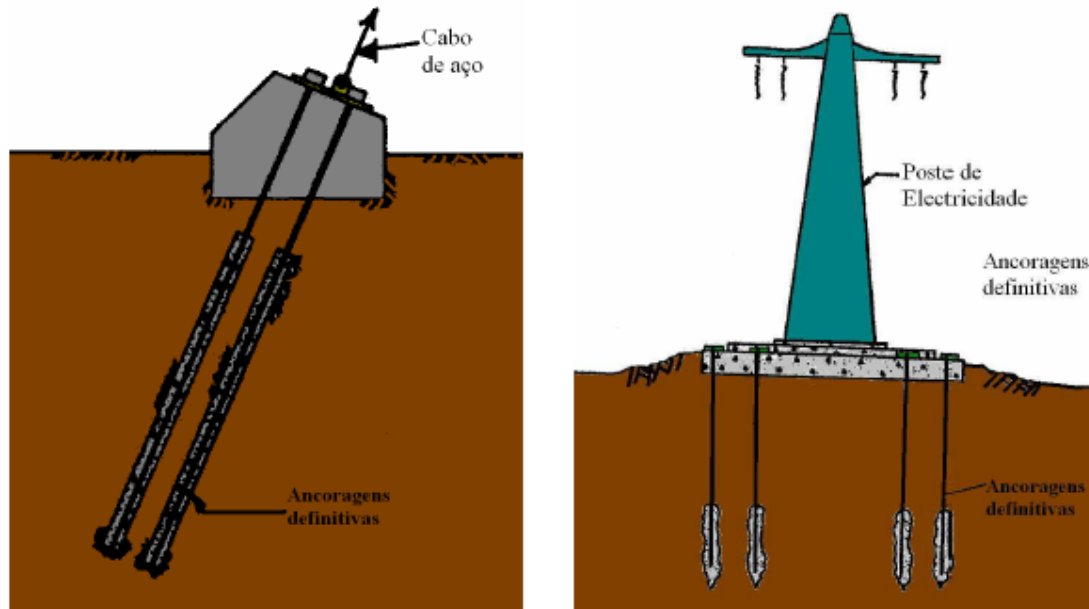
Exemplos de aplicação ancoragens verticais e sub-verticais [9]
